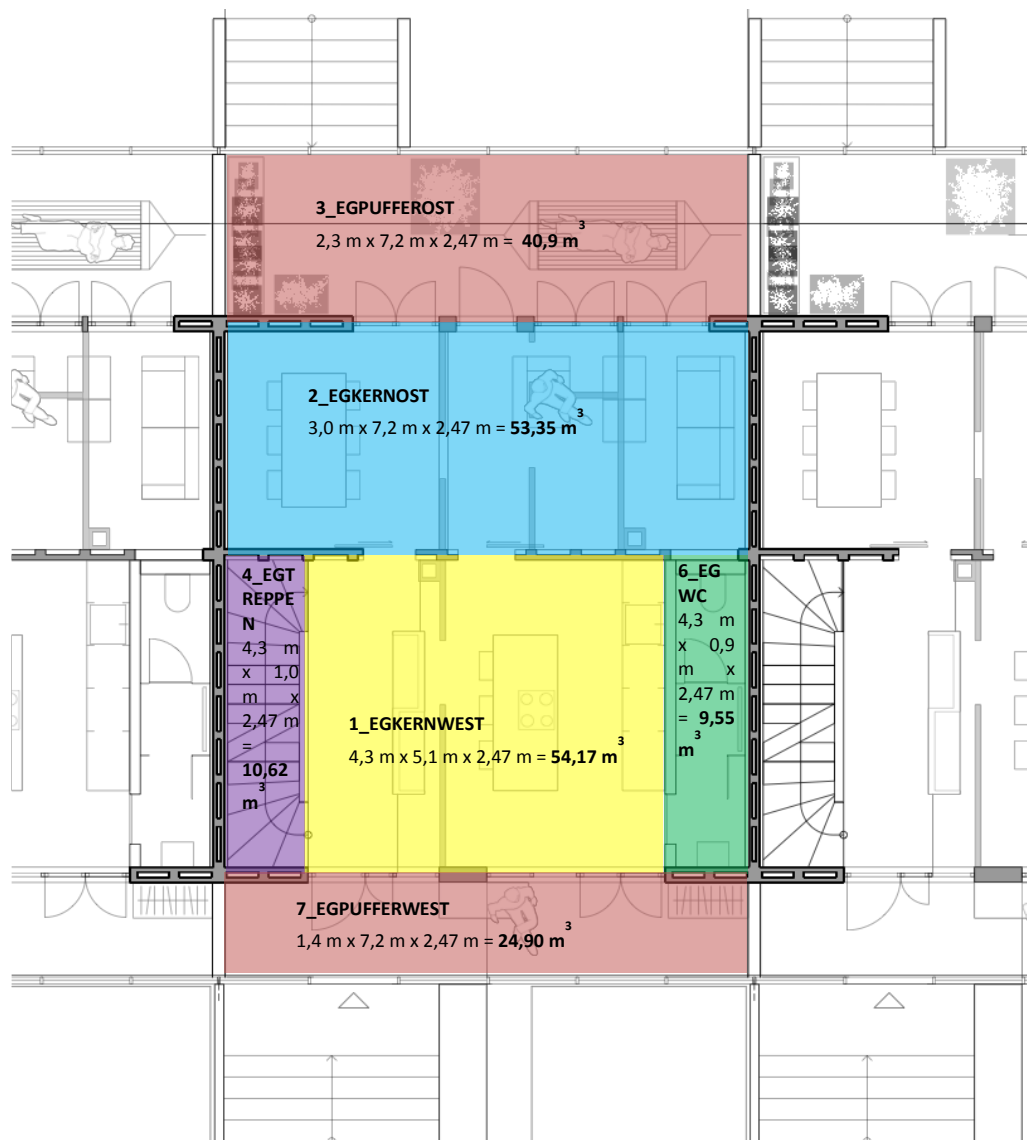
Grundriss Erdgeschoss. Quelle:
